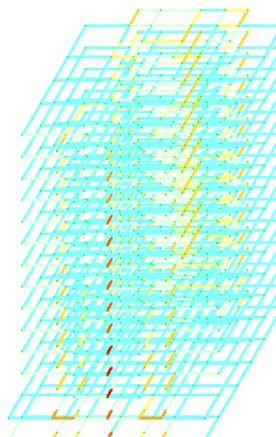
Площадь арматуры ASW2 поперечной ригель
